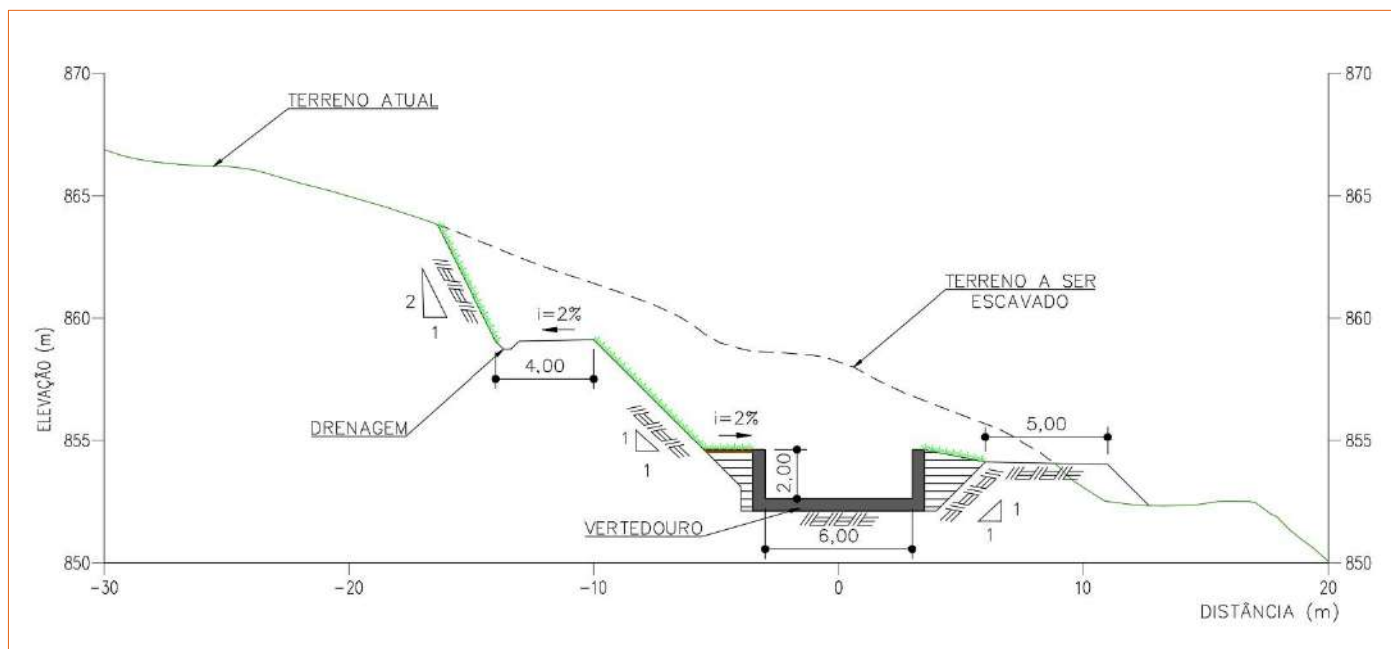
Seção típica da escavação - trecho até a seção 6+10,0 m
